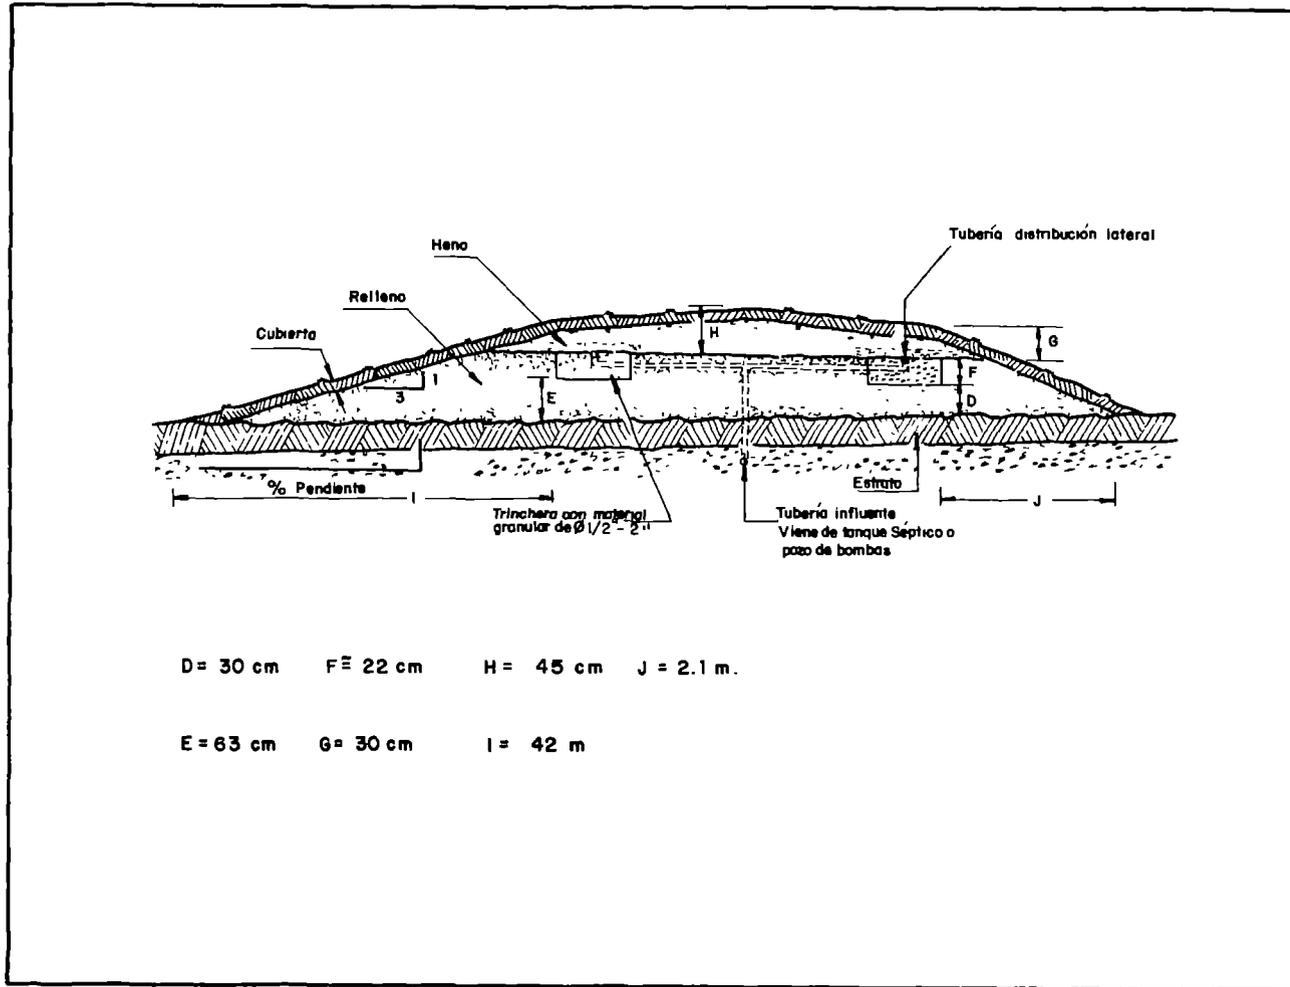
Sección transversal de un montículo que utiliza dos trincheras como área de absorción. Ejemplo 11-1.
